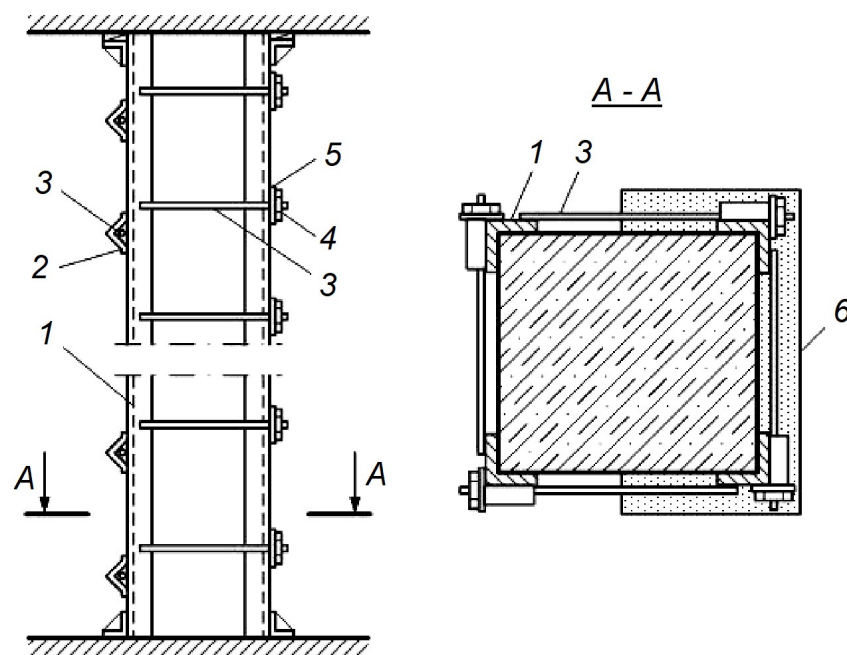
Влаштування опалубки при підсиленні цегляного простінка залізобетонною обіймою
